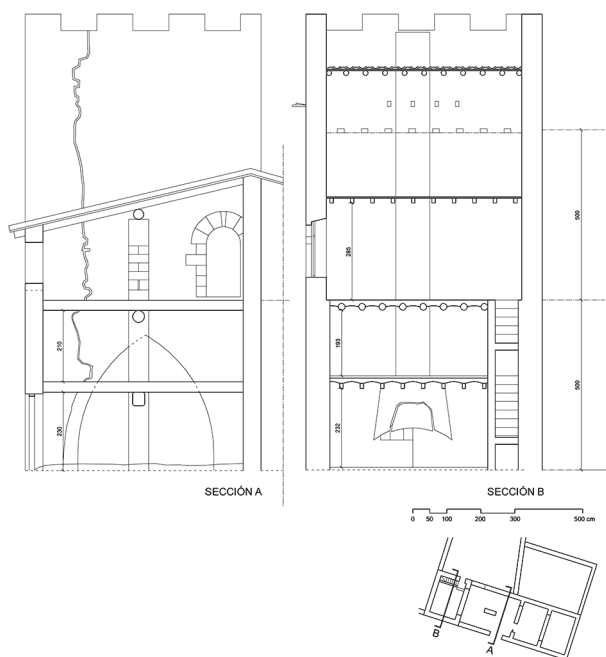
Planos de sección de Torre Camañes —Cantavieja—.
